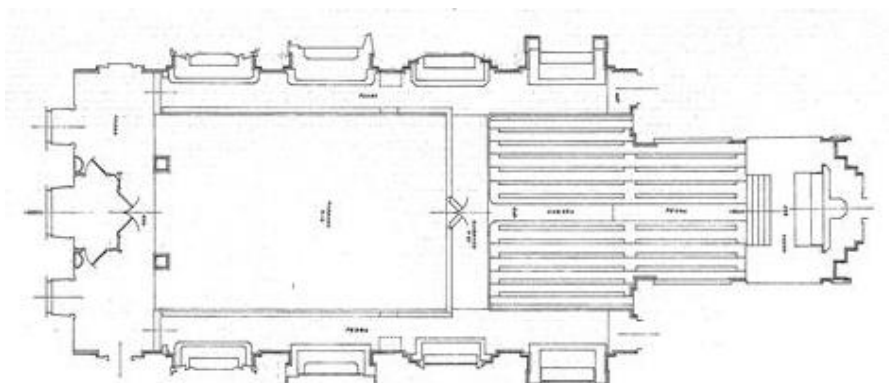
Planta da nave e capelas da Sé Catedral de Santarém
